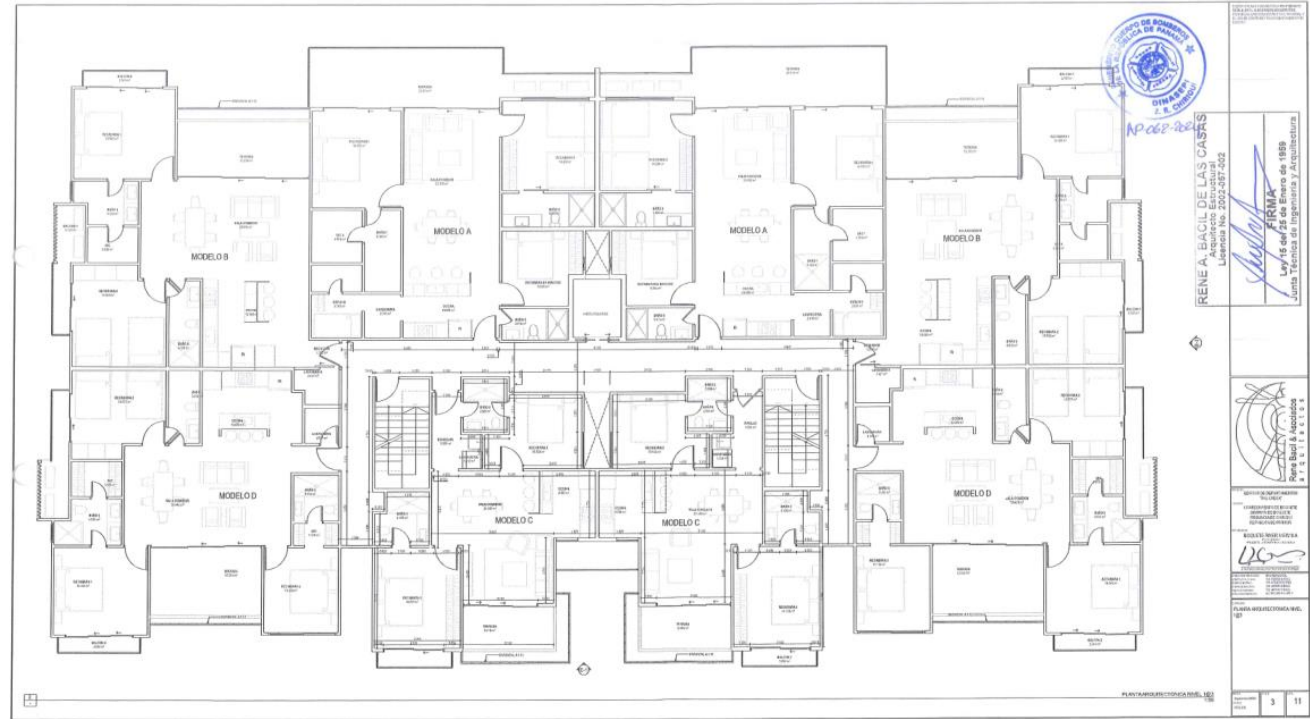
PLANTA ALTA 1@3 “BOQUETE RIVER VIEW”
